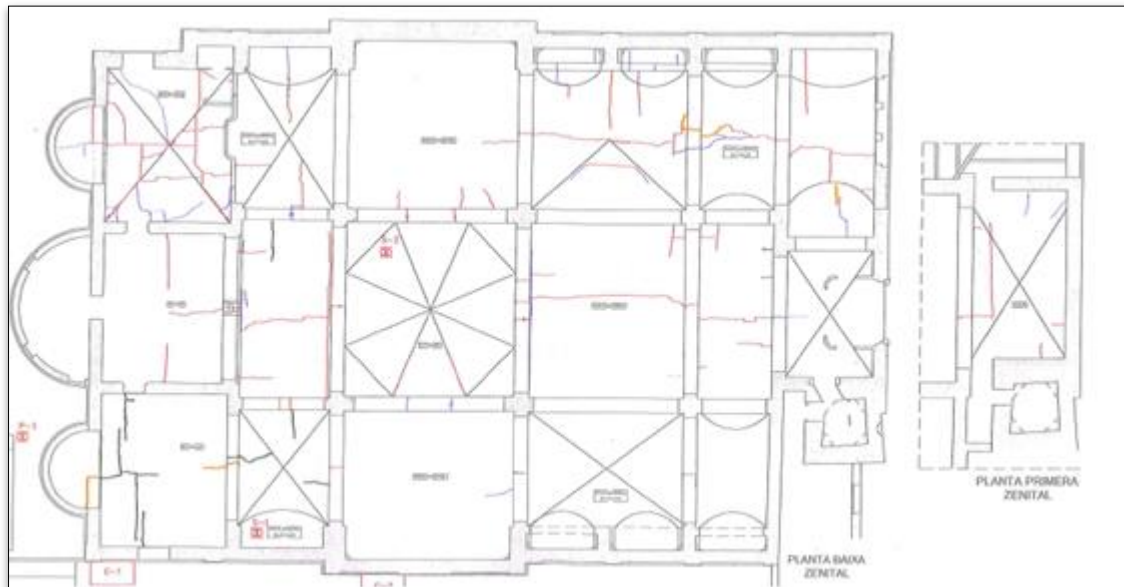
Grietas techo (plano PAT. 03)
